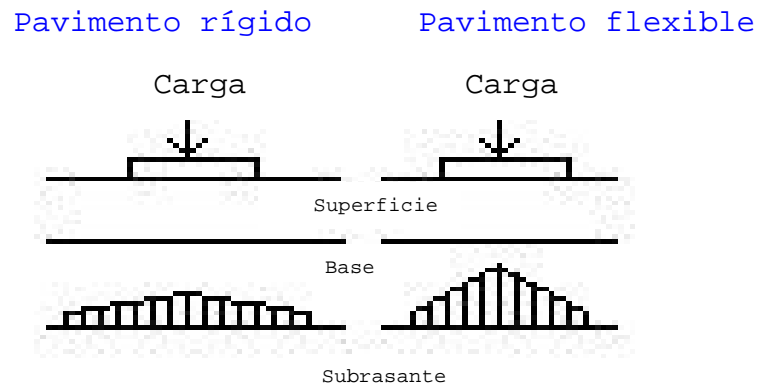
Distribución de carga característica de un Pavimento rígido versus uno flexible
